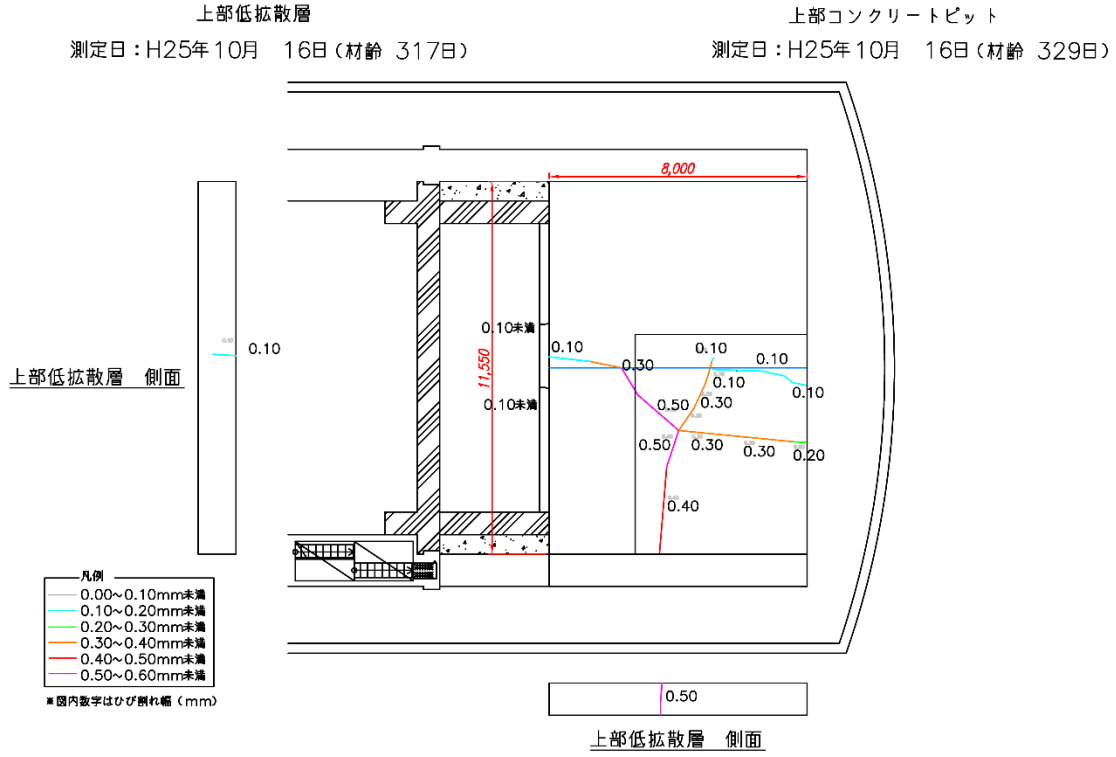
上部コンクリートピットおよび上部低拡散層のひび割れ履歴図（その1）
